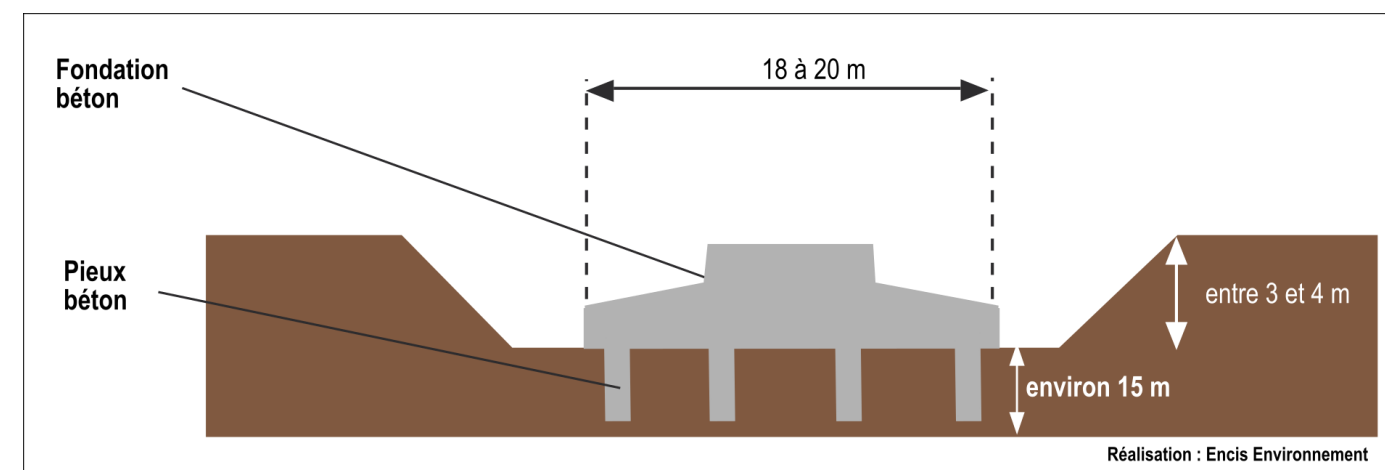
Schéma d'une fondation sur pieux pour l'éolienne E2
